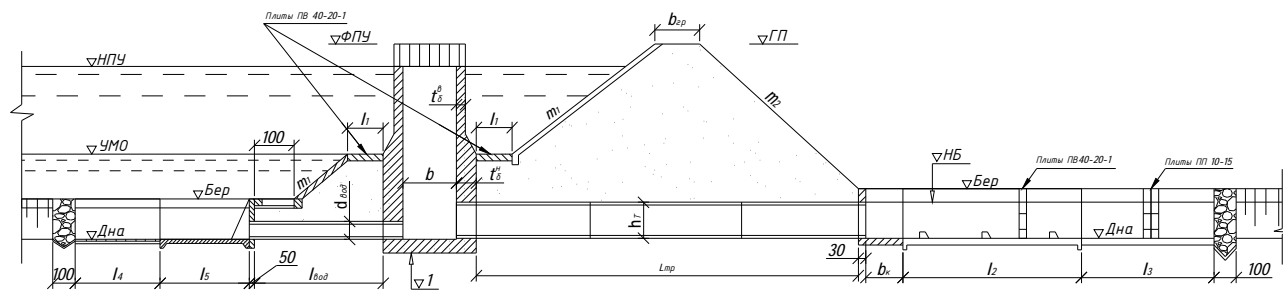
Расчетная схема шахтно-башенного водосброса
